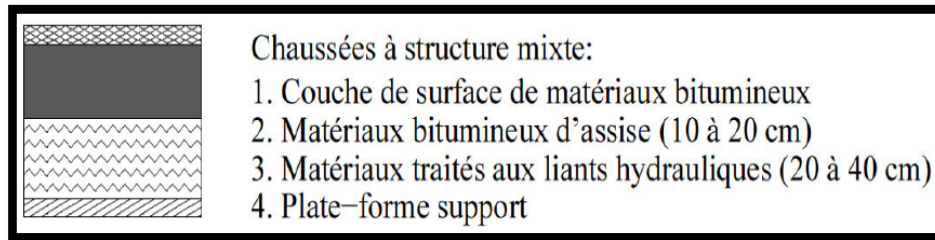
Chaussées à structure mixte (LCPC, 1994).
